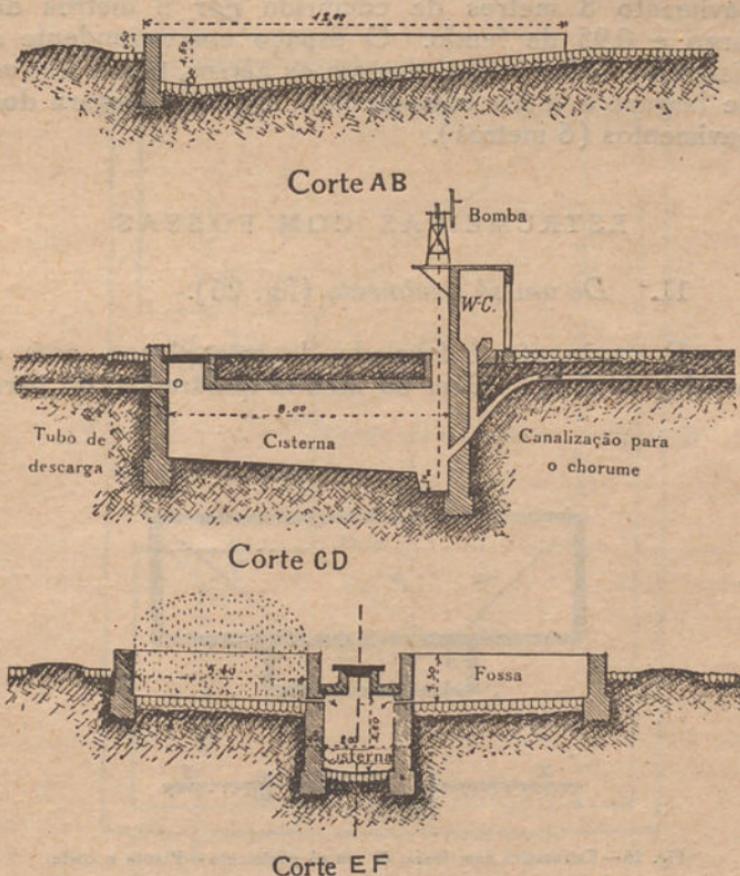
Estrumeira de pavimento duplo — Cortes
